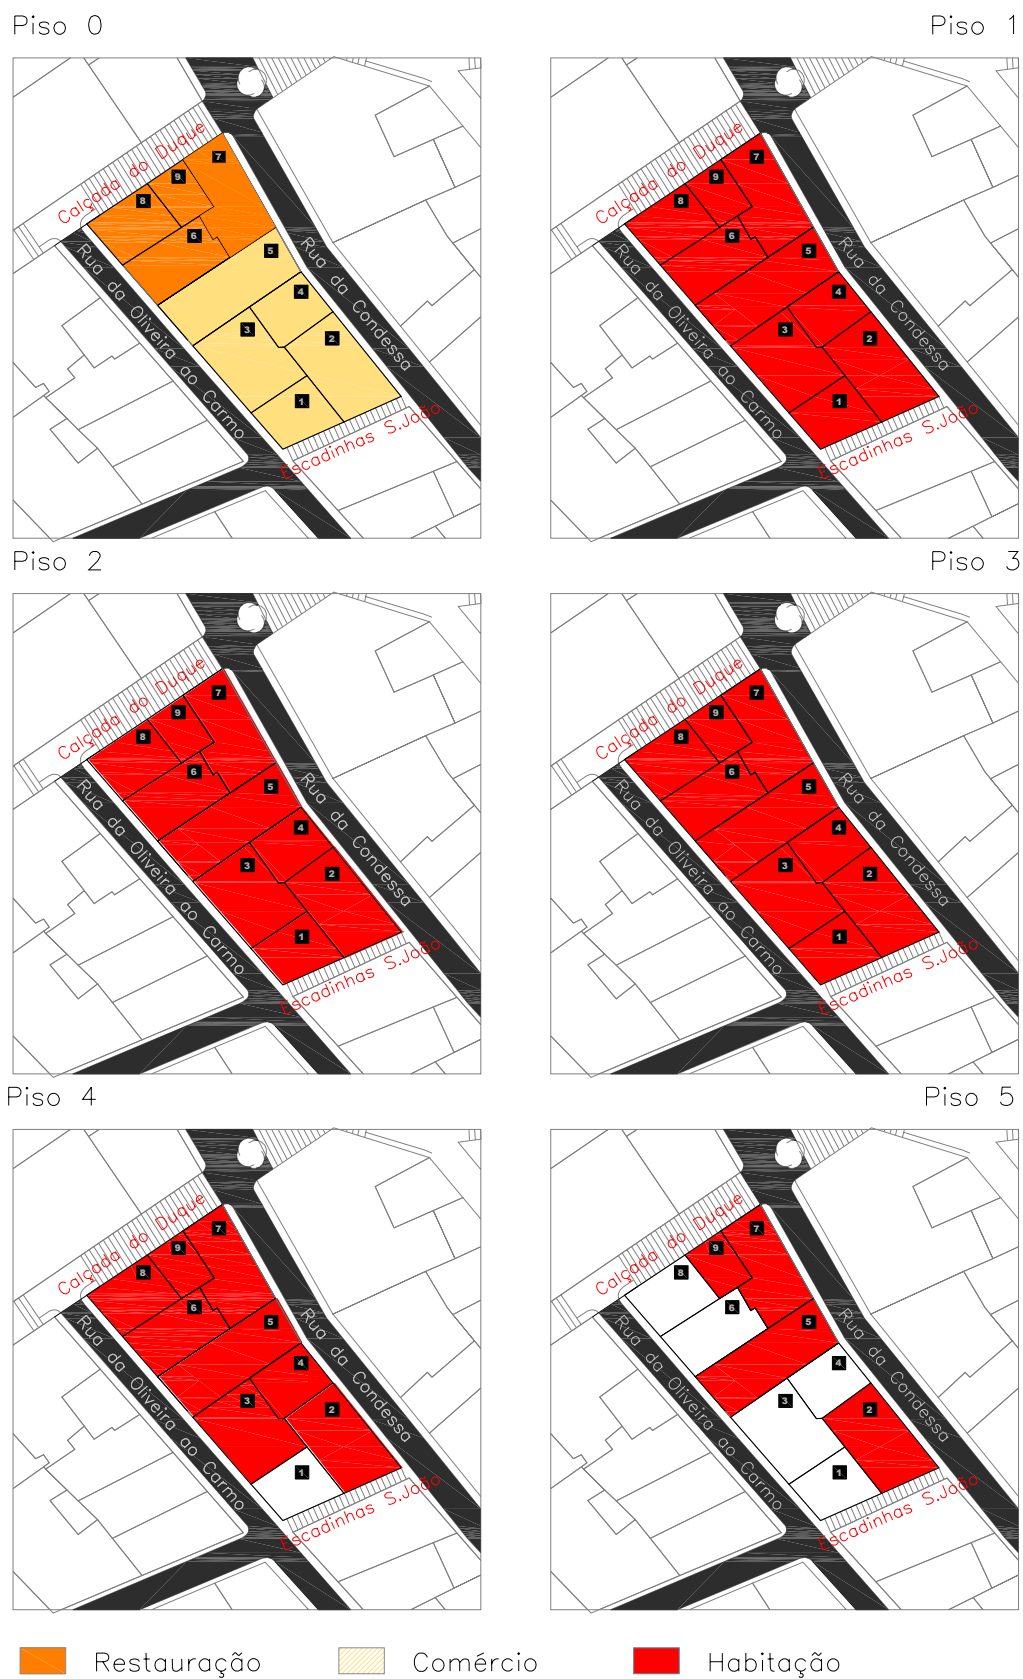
Plantas de Zonamento e Organização Espacial por piso
